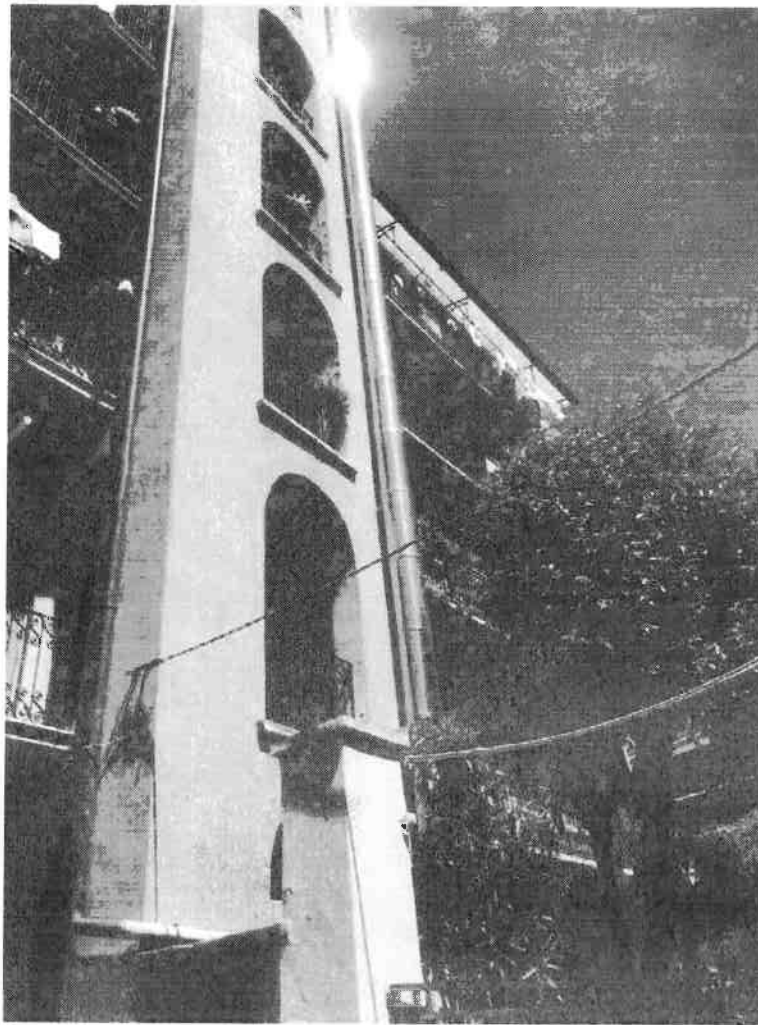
situazione prospetto lato cortile interno durante il sopralluogo del 18.05.2021 – foto 2
